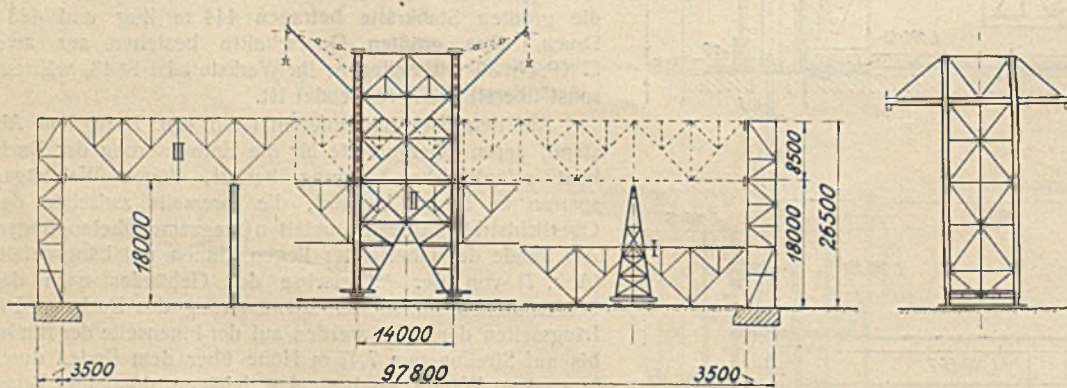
Aufstellung der Binder mit Gerüstkran.
